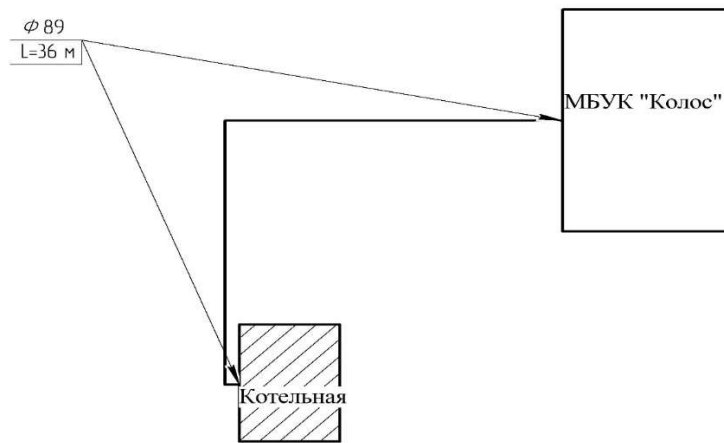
Схема тепловых сетей котельной №5-5
